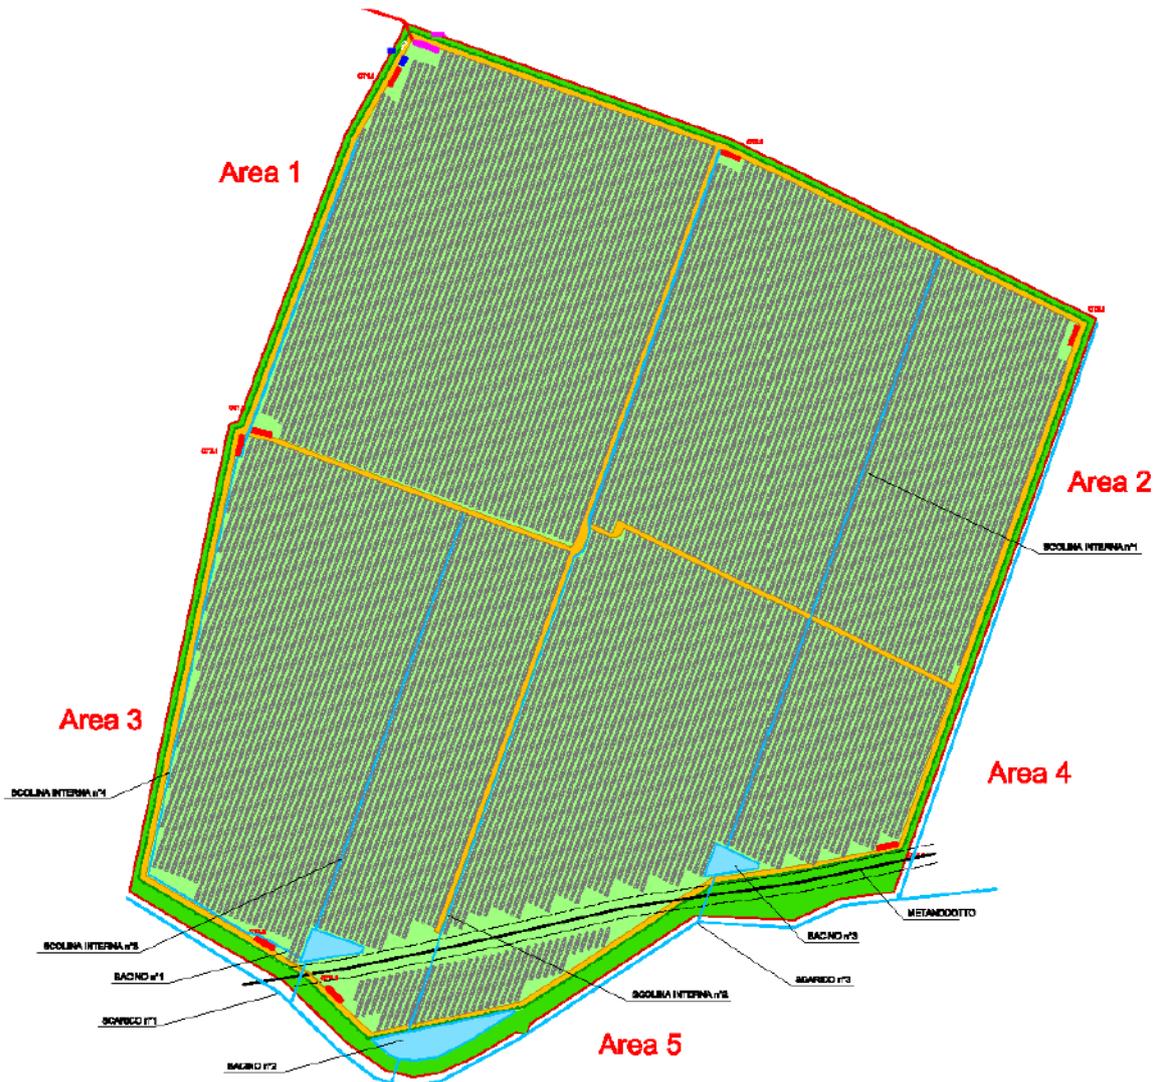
Planimetria generale - ubicazione dei bacini di laminazione e punti di scarico
